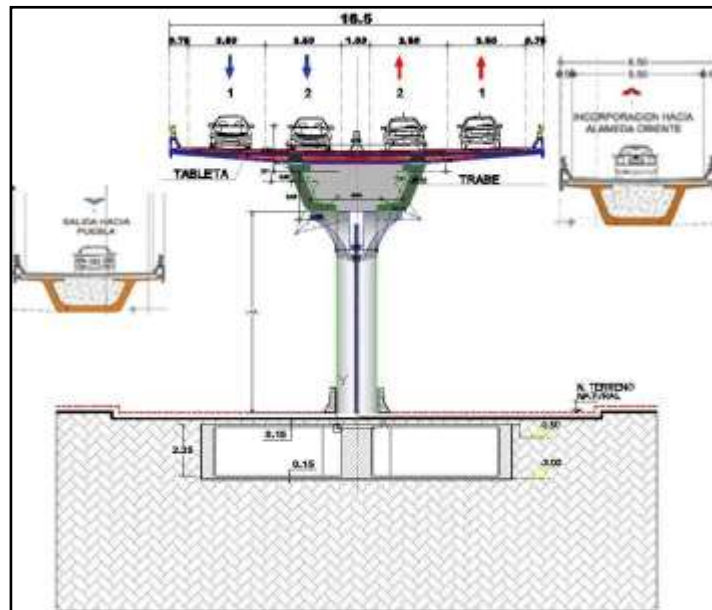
Sección en zona de rampas de acceso y salida de la vialidad elevada nivel +1.
